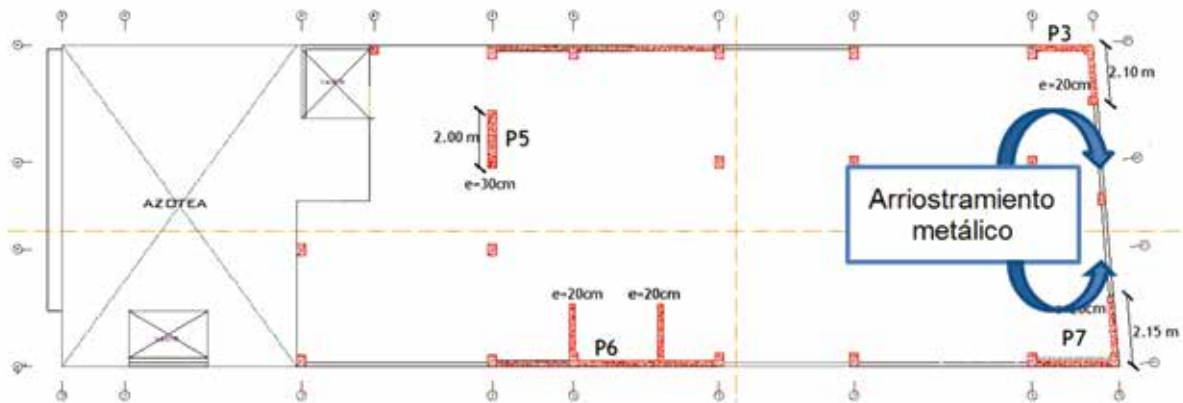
VISTA EN PLANTA – ELEMENTOS DE CORTE (6TO NIVEL)
